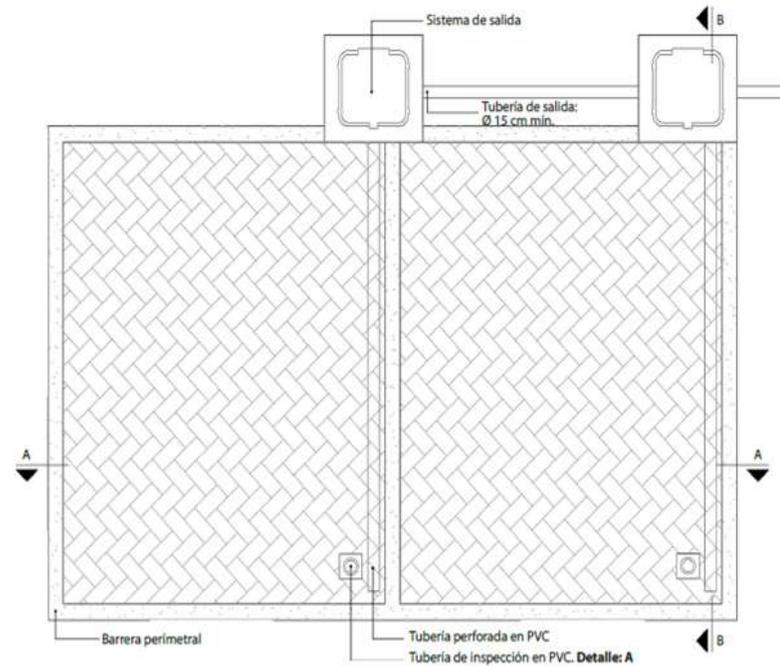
Planta: Pavimento permeable de tipo adoquines entrelazados
